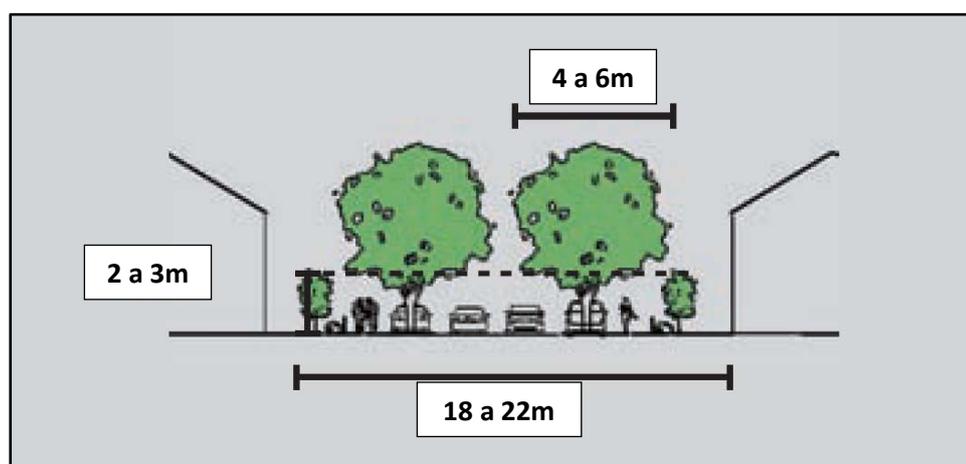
Tipología del perfil transversal de las calles terciarias.
